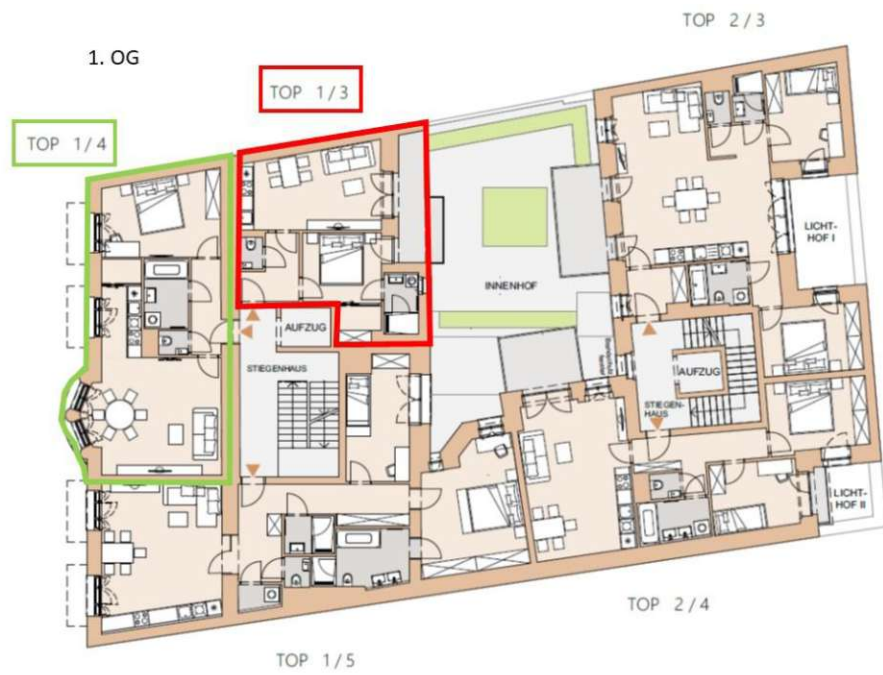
Grundriss 1. Obergeschoß Kleine Spargasse 5. Quelle: ARE
